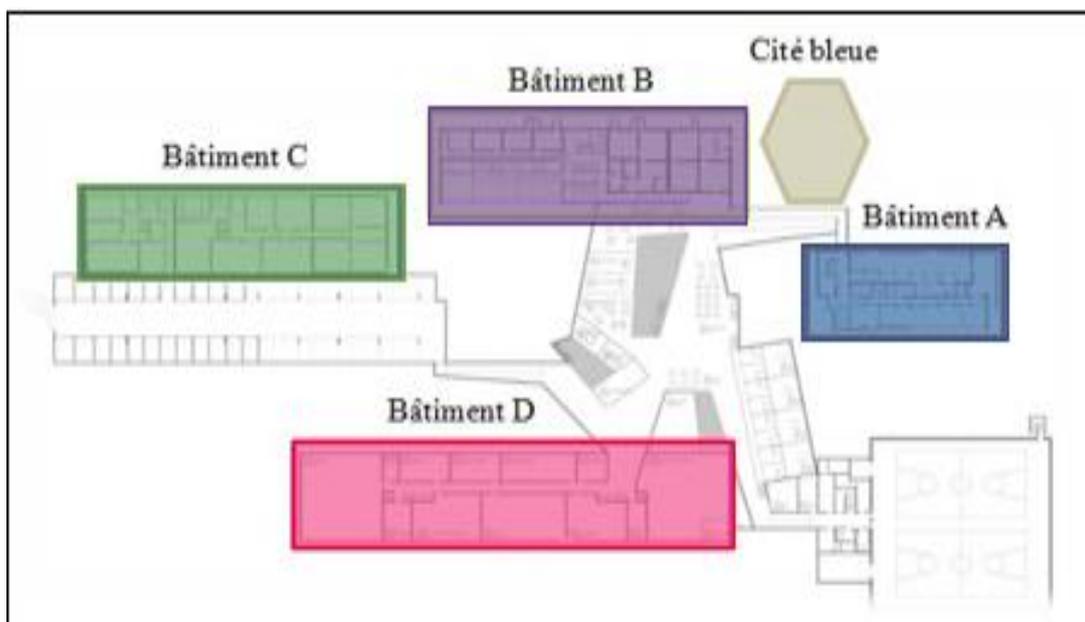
La CUG, Plan de rez-de-chaussée
